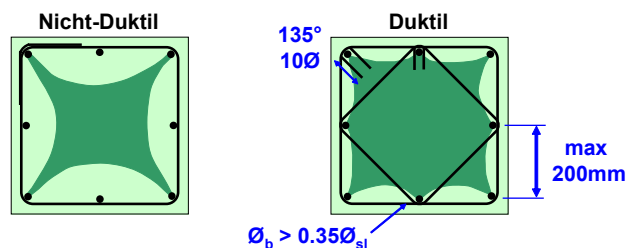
Anordnung der Umschnürungsbewehrung bei Stützen. (Heller Bereich: abgeplatzter Beton. Dunkler Bereich: Betonkern).
